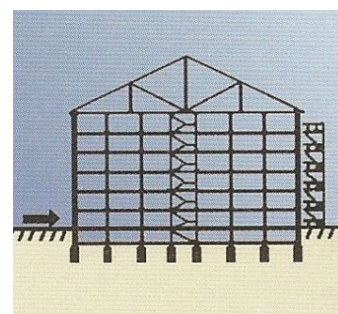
Ilustração do tipo de estrutura de edifícios de tijolo Gaioleiro
